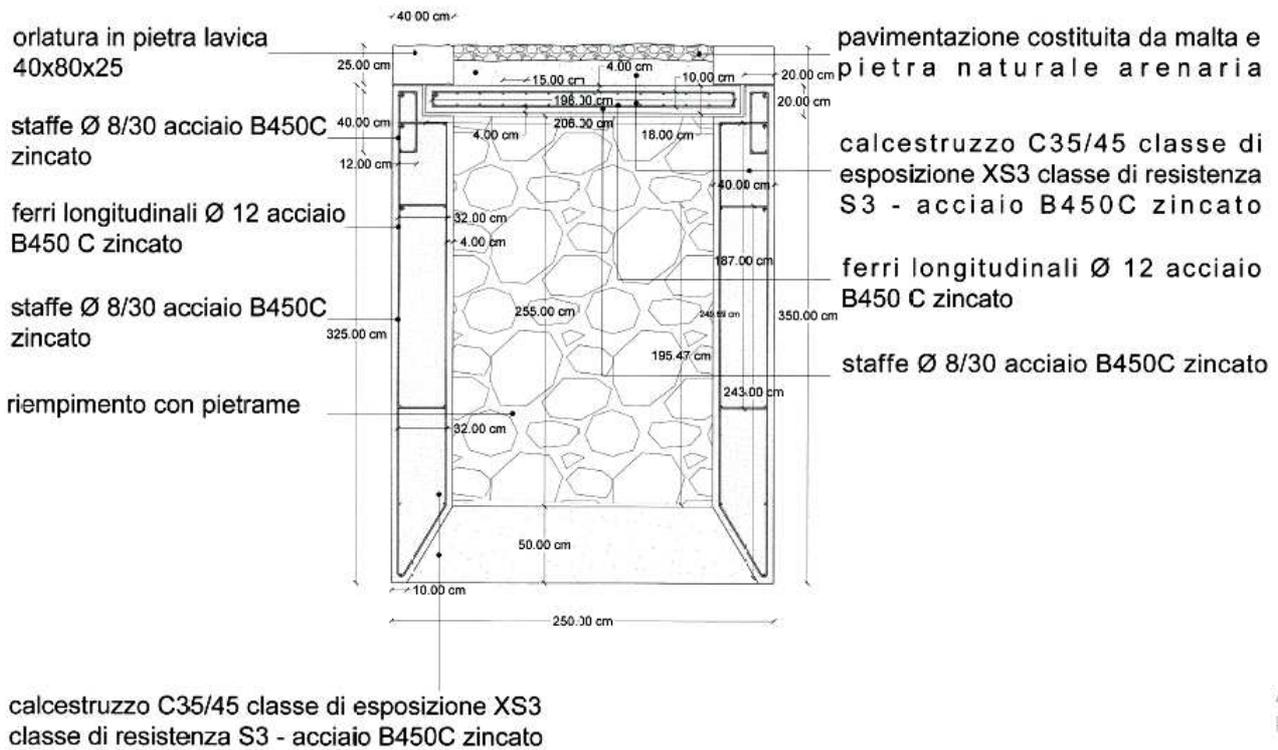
Sezione-tipo trasversale del pontile di progetto.
